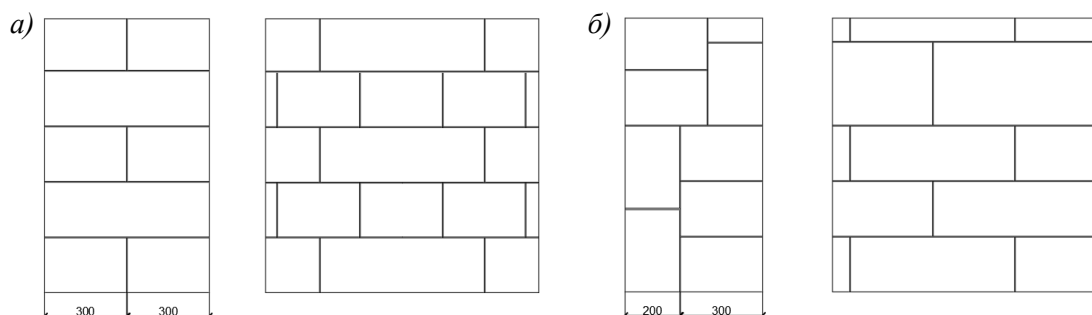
Поперечный разрез и общий вид кладок из ячеистобетонных блоков:
